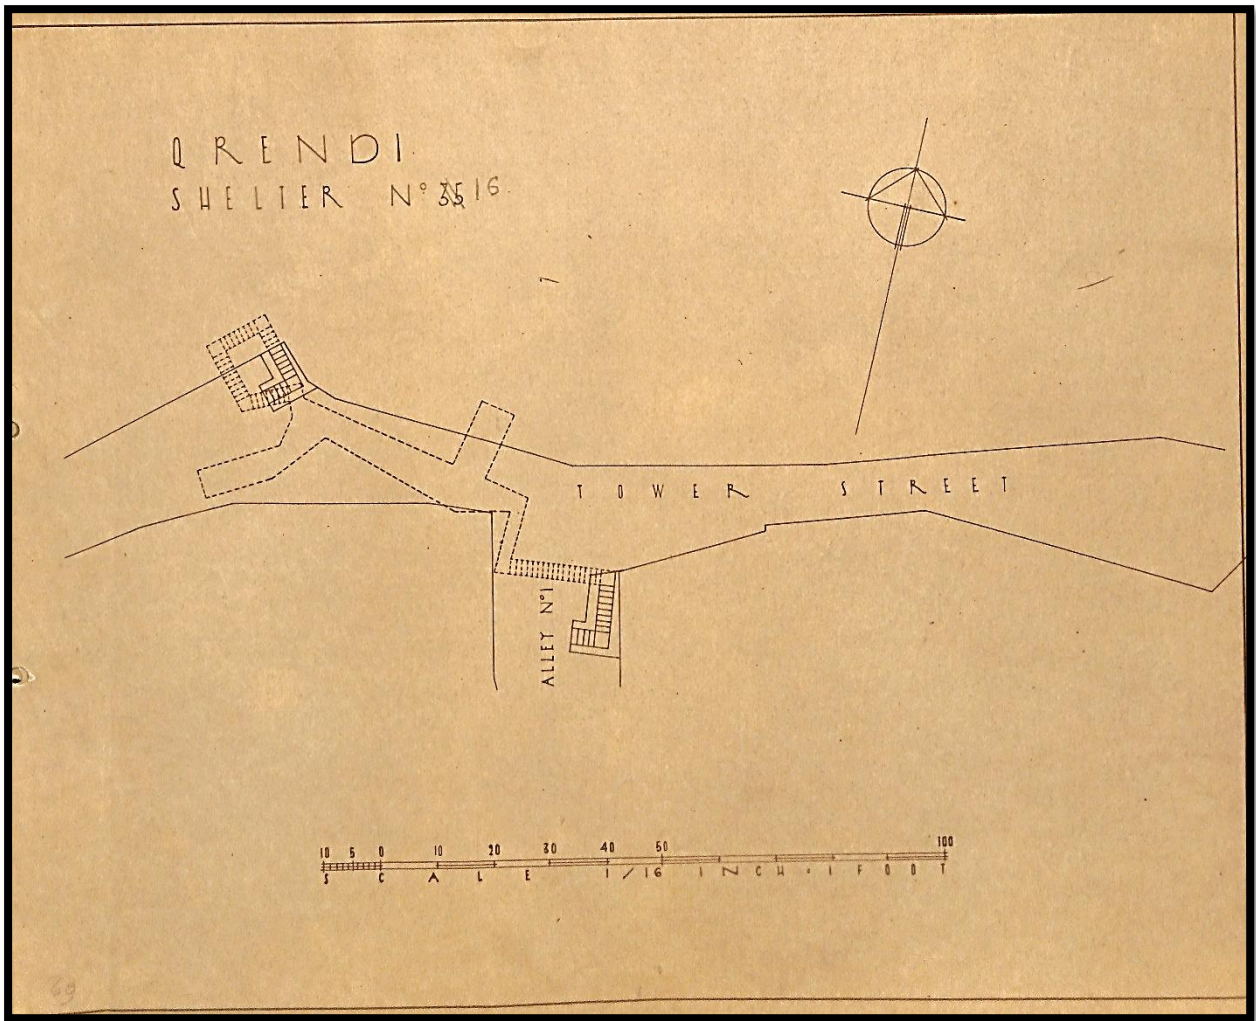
Planta do Abrigo nº16 "Tower Street – Alley nº1."
